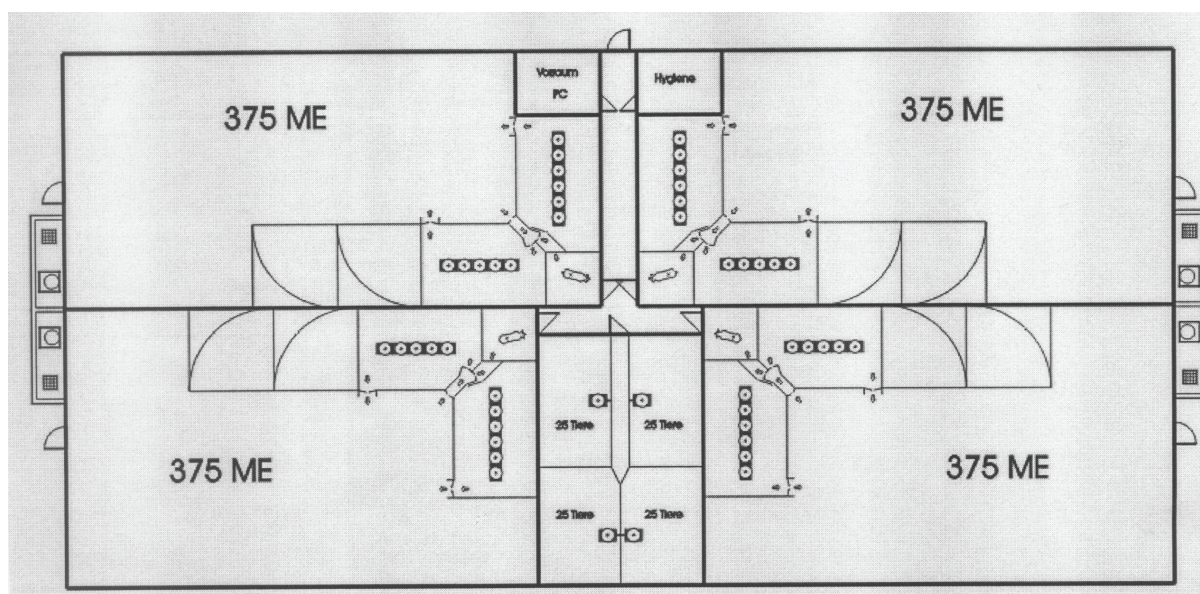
Grundrisslösung mit 4 Großgruppen
